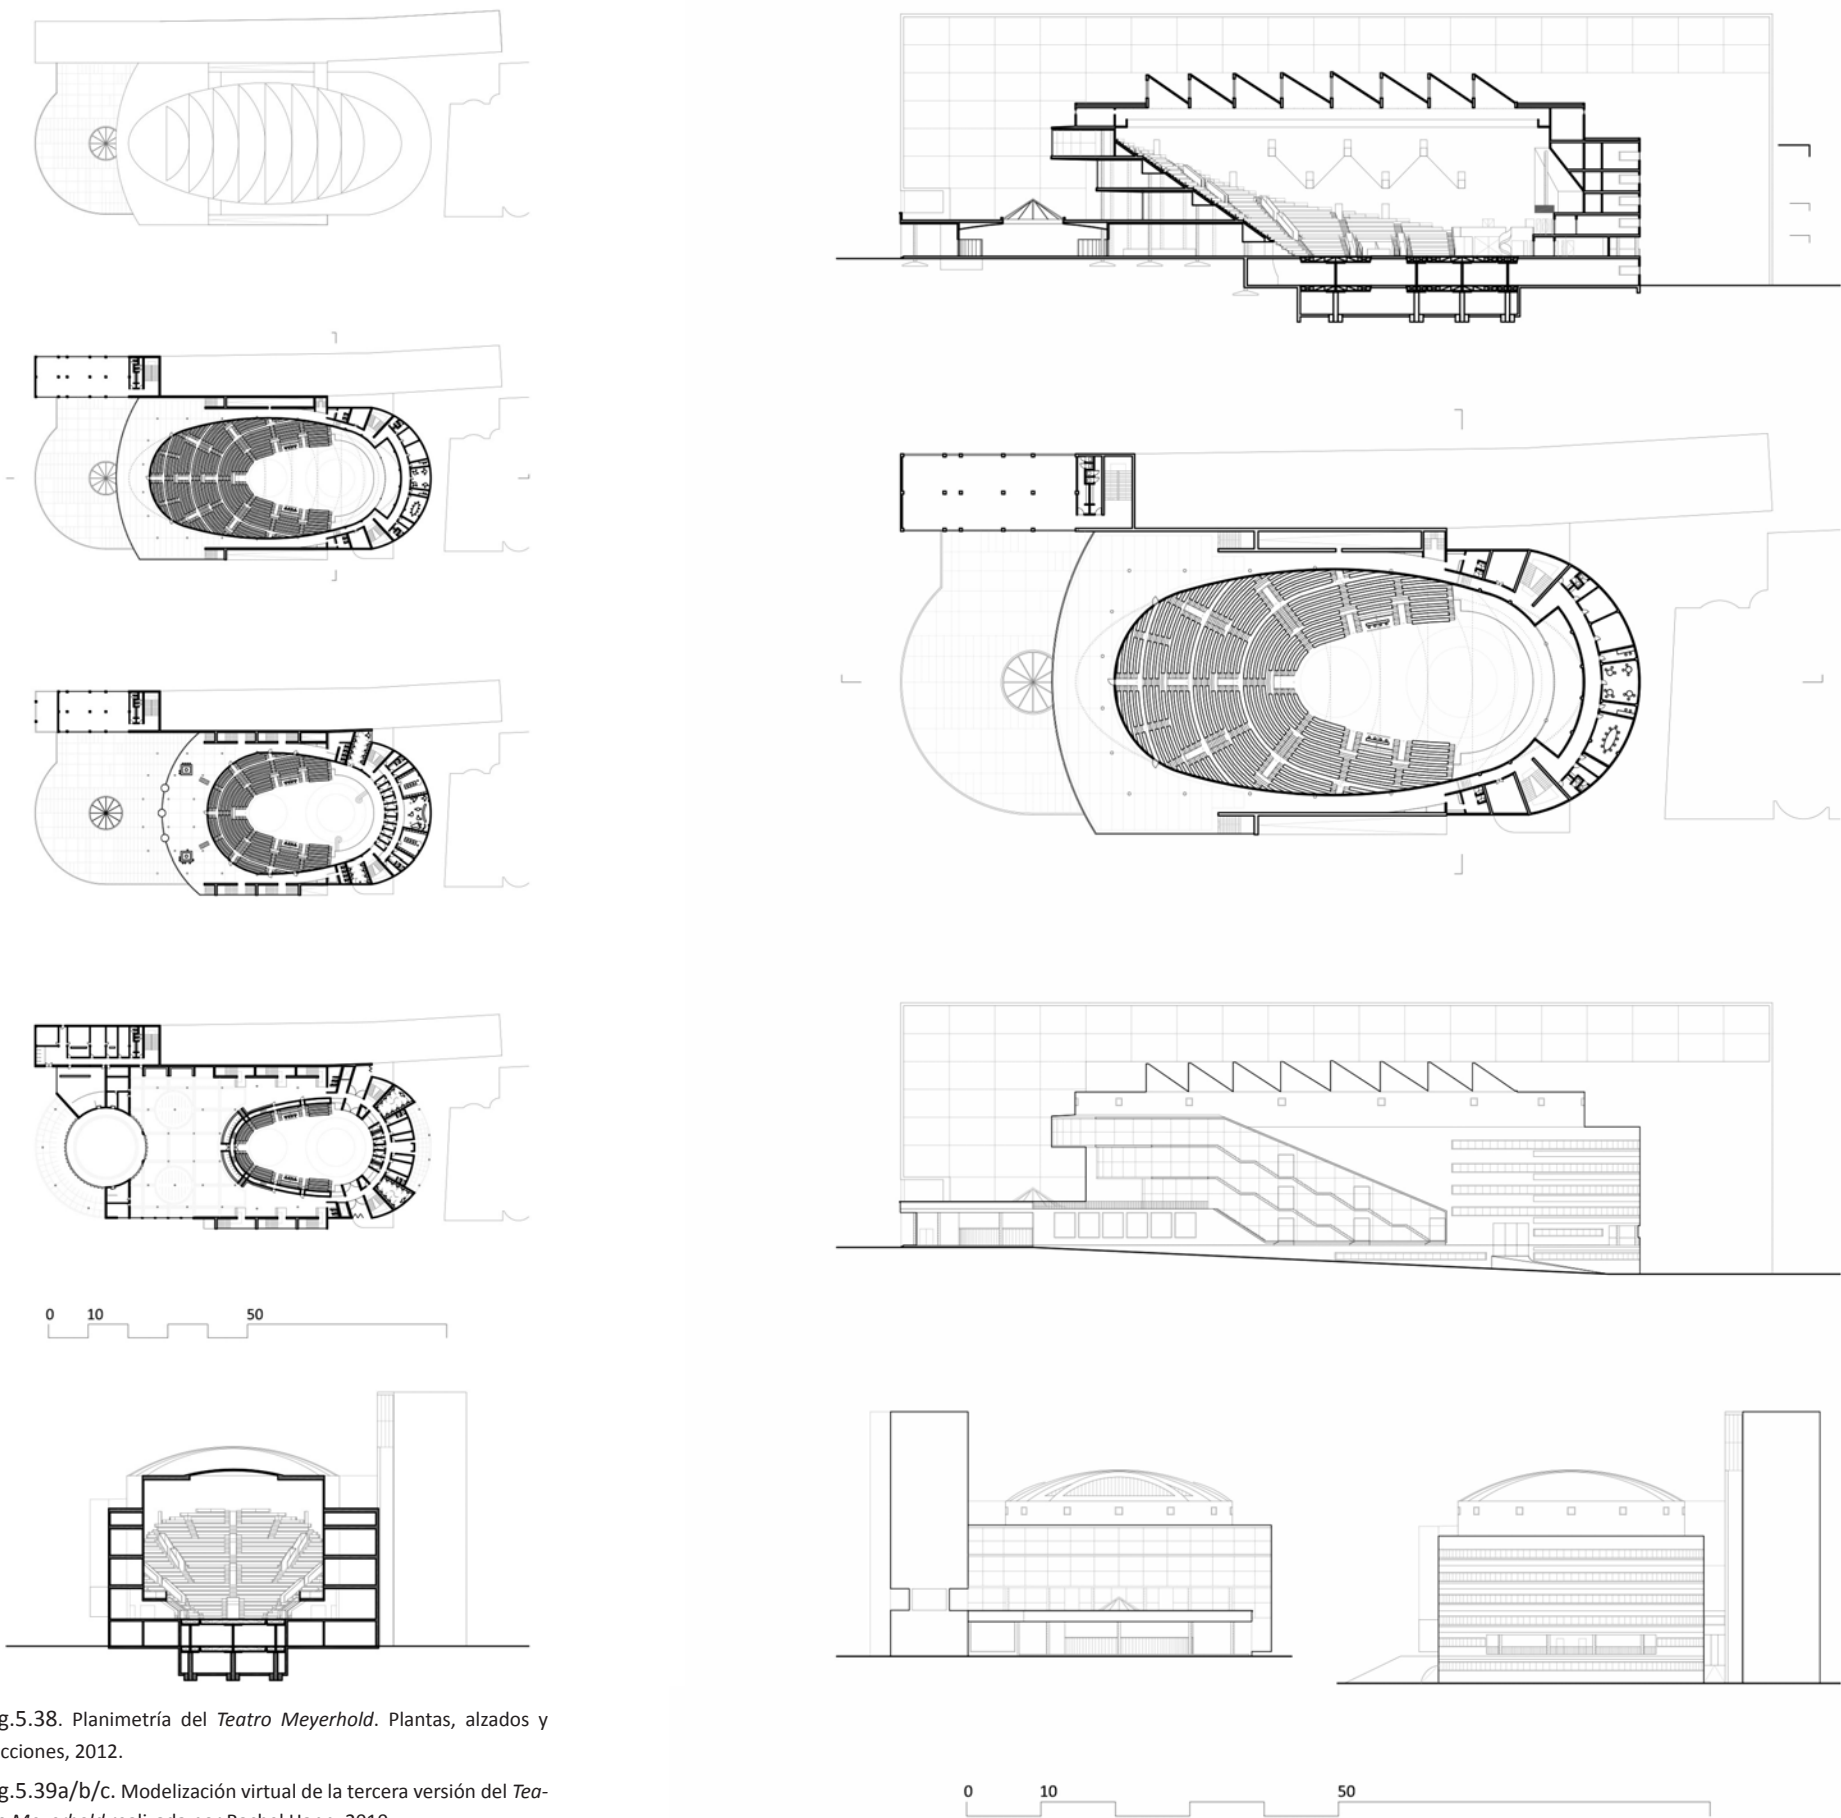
Planimetría del Teatro Meyerhold. Plantas, alzados y secciones, 2012.
